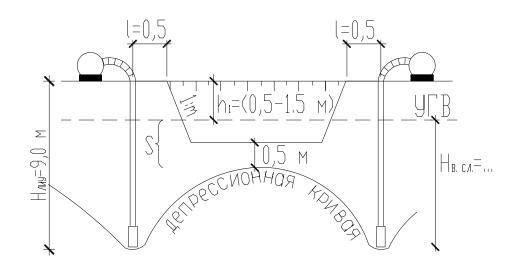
Расчетная схема водопонижающей системы ЛИУ относительно котлована
